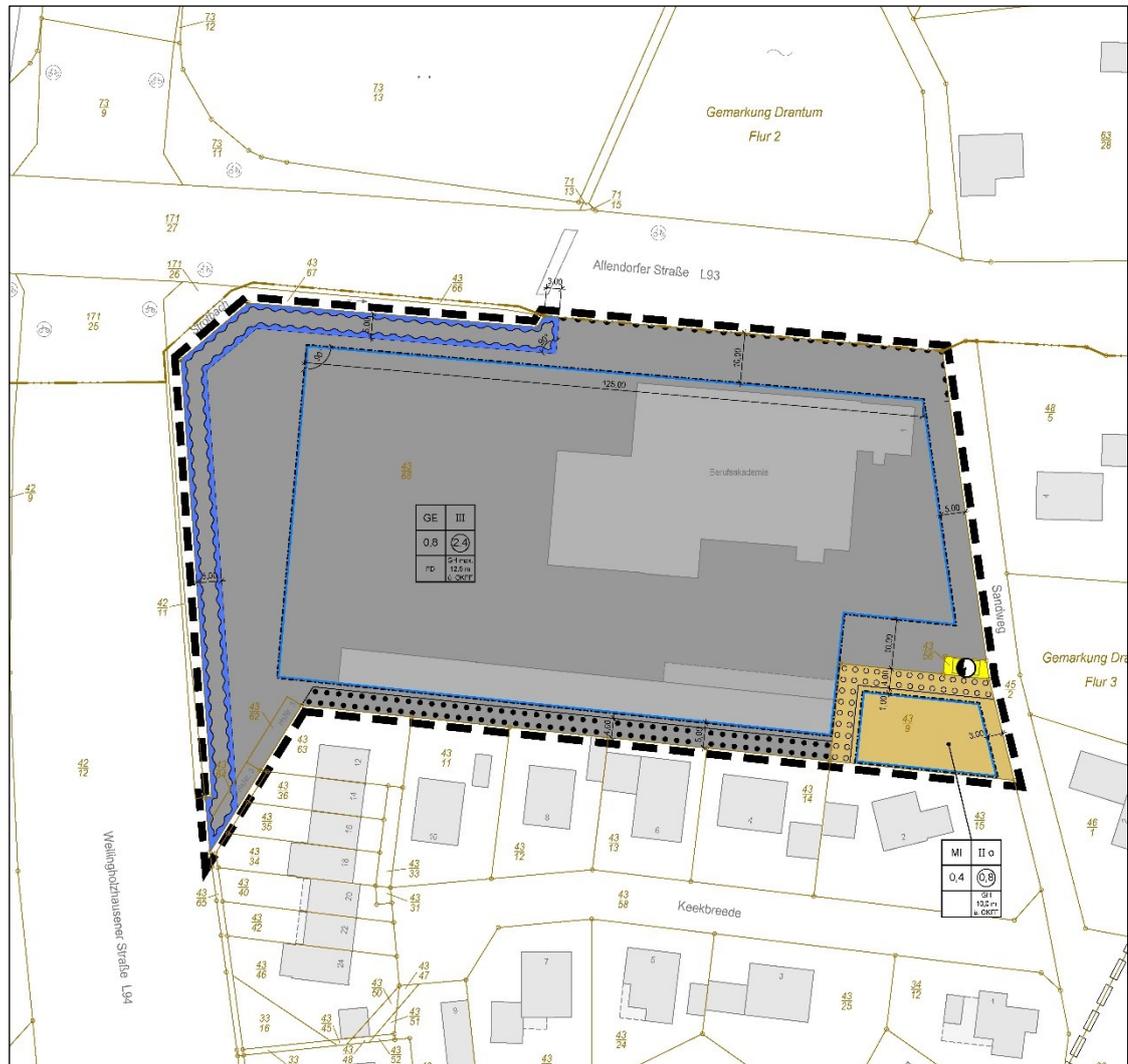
Ausschnitt aus dem Entwurf des Bebauungsplanes Nr. 31 [7]
